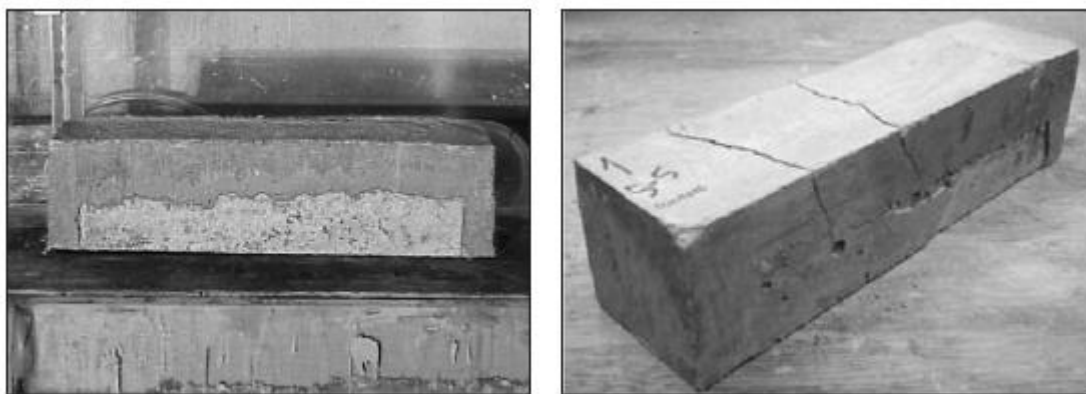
Pieza de hormigón durante el ensayo y tras la aparición de fisuras [11].
